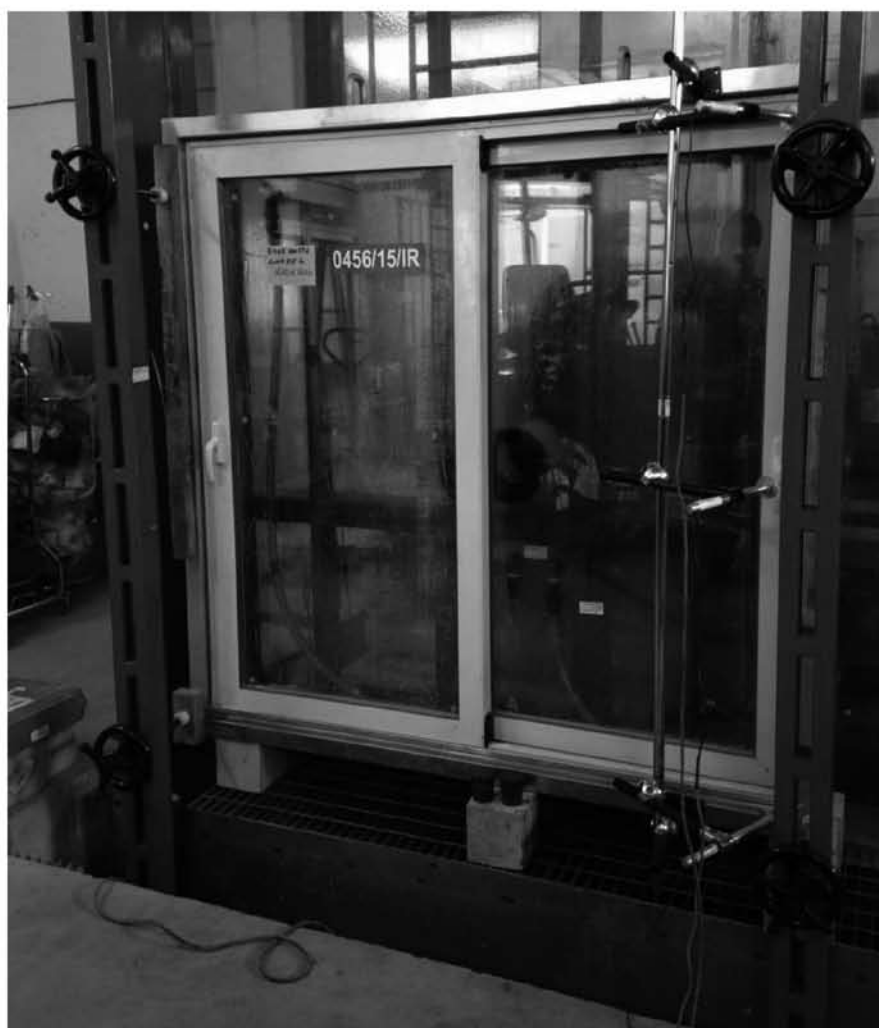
Campione pervenuto e sottoposto a prova nell'assetto sperimentale (prova di deformazione)
